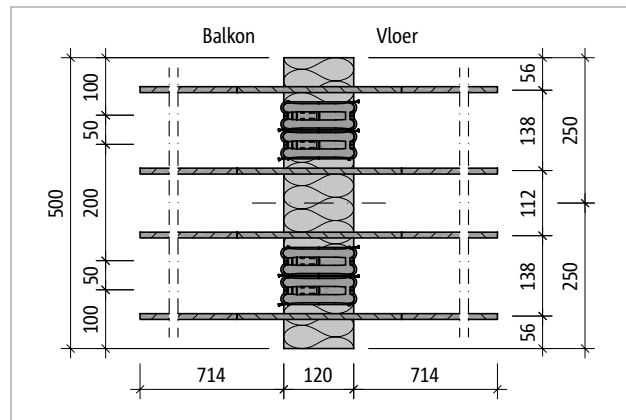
Schöck Isokorf® XT type Q-E-V5 bij: Doorsnede
